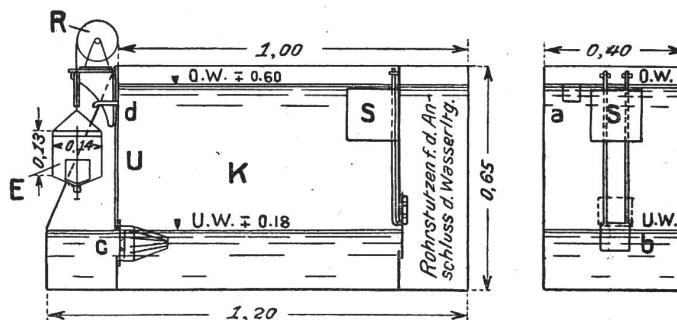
Fischschleuse, System Recken. Modell. Längsschnitt und Ansicht vom Oberwasser aus. Maßstab 1 : 20.
